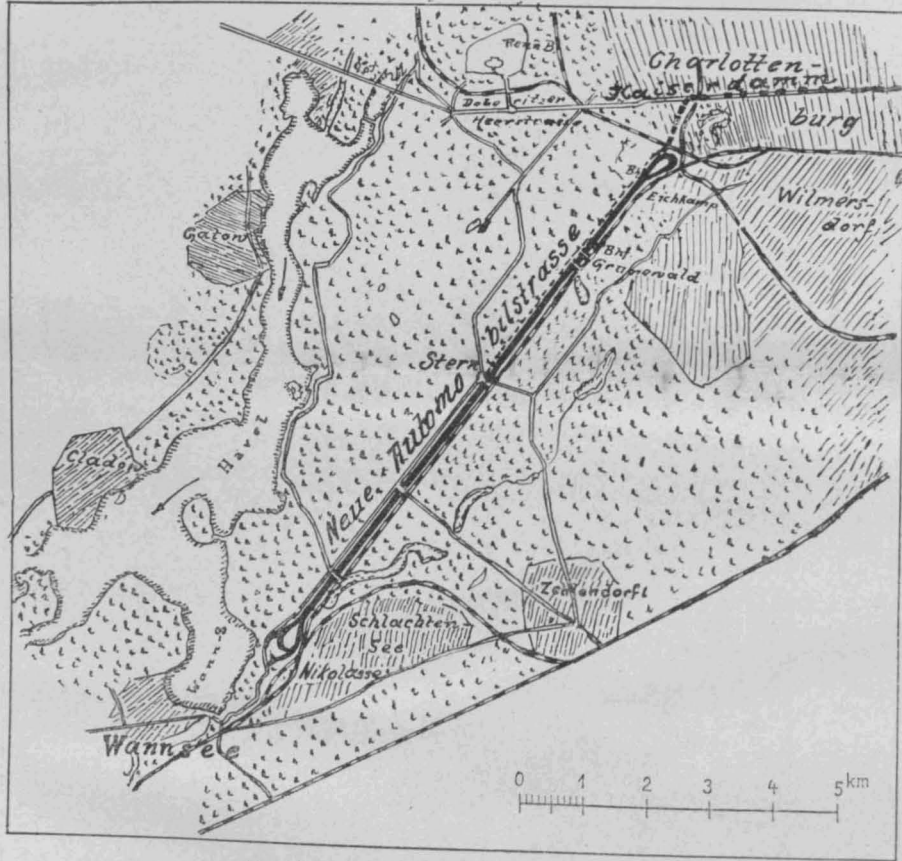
(oben). Lageplan der Automobil-Straße.
